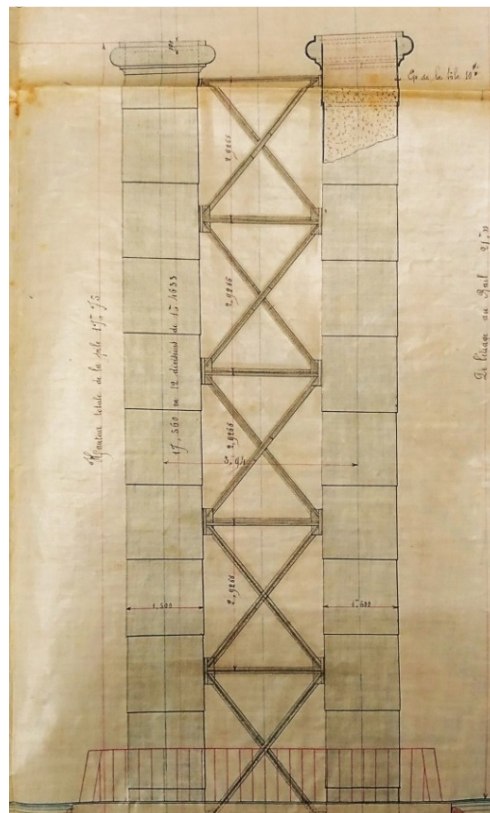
Pilares tubulares da Ponte de Barcelos [19]
